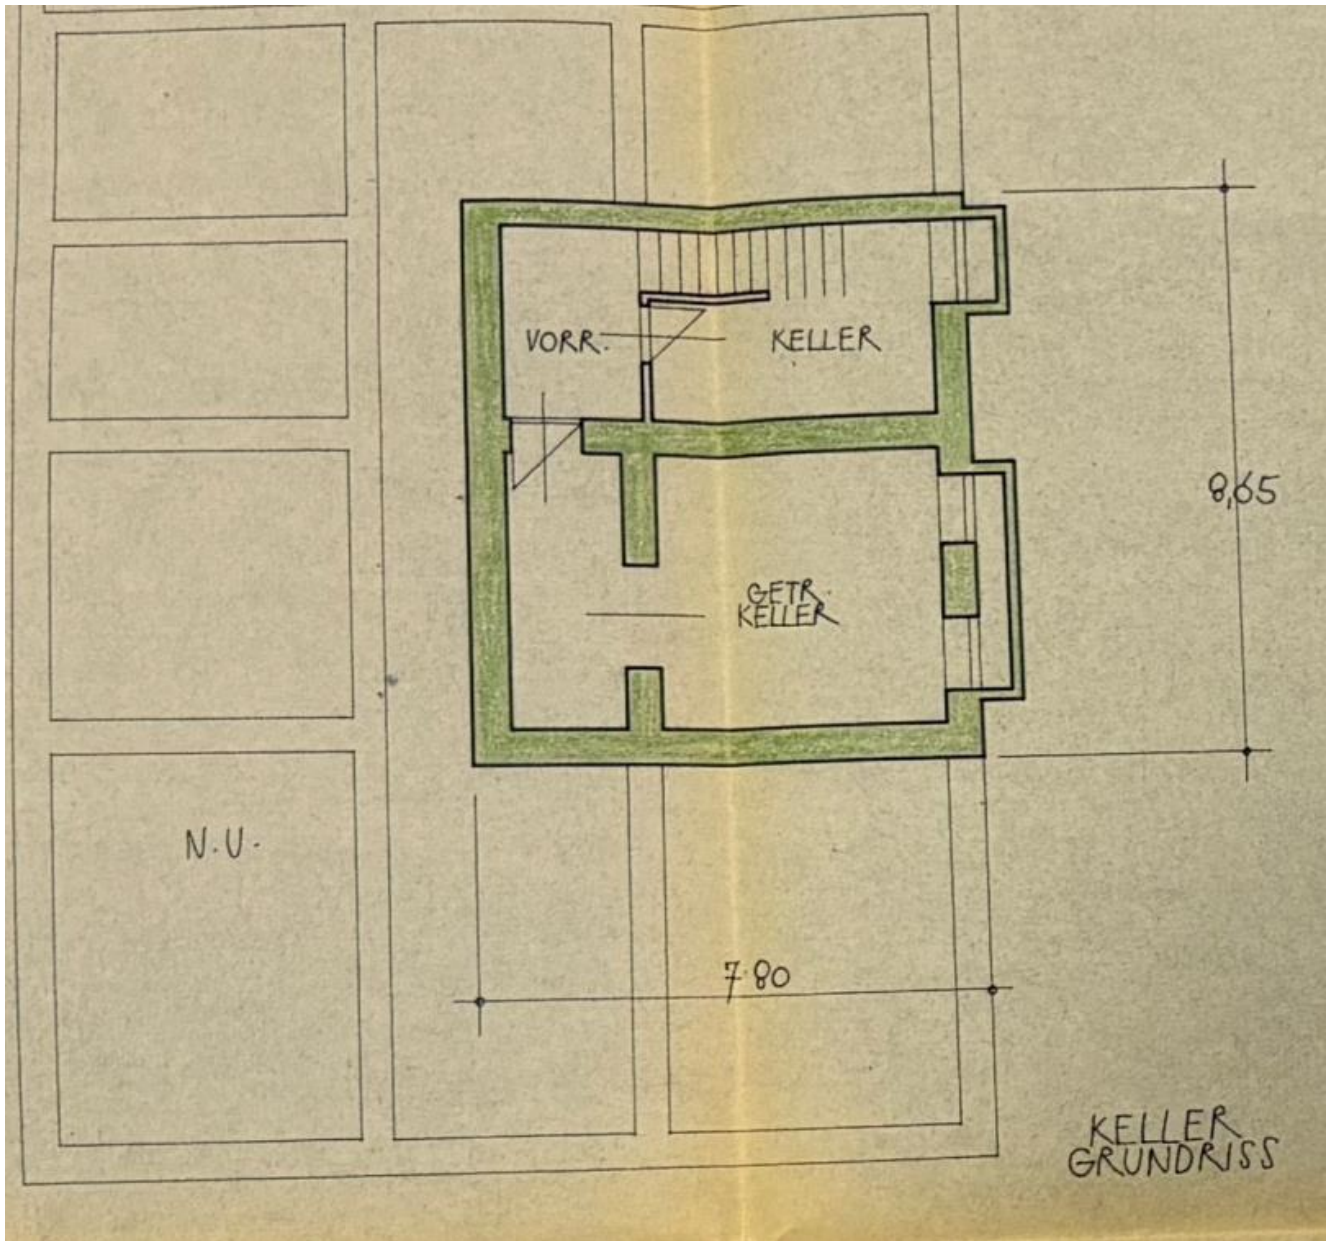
Grundriss Kellergeschoss (1967)
